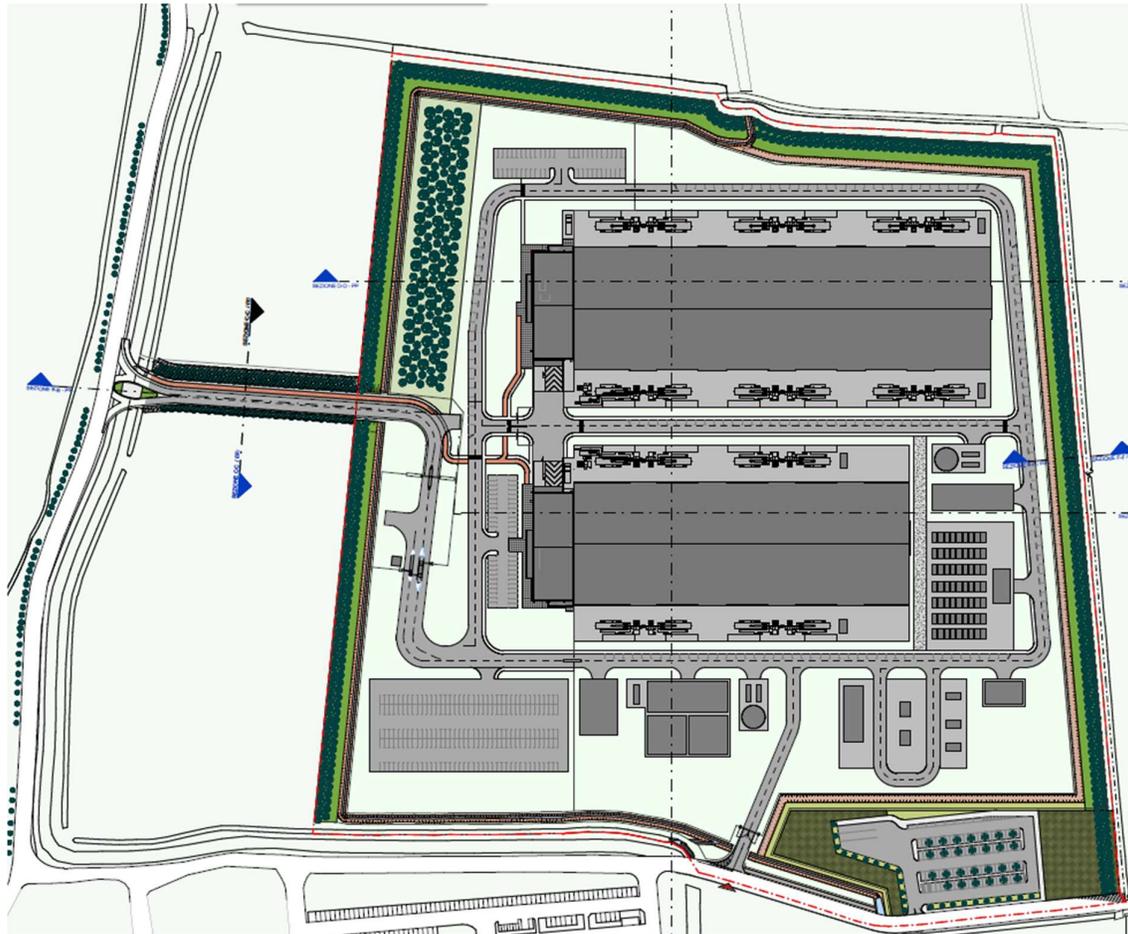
Planimetria proposta paesaggistica del piano attuativo
